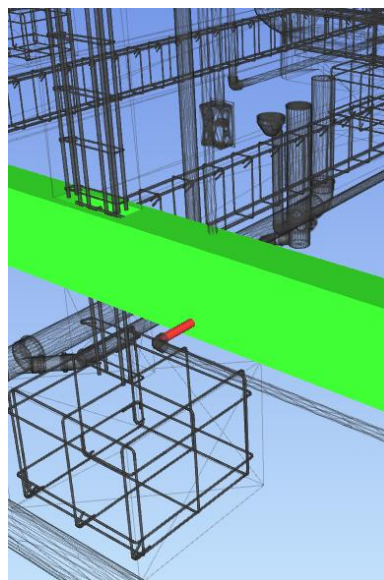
Interferência entre tubulação (vermelho) e viga (verde)
